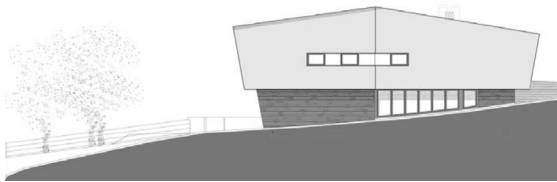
Prospetto su-est; Fonte: A. Troi, et. al., 2009;
